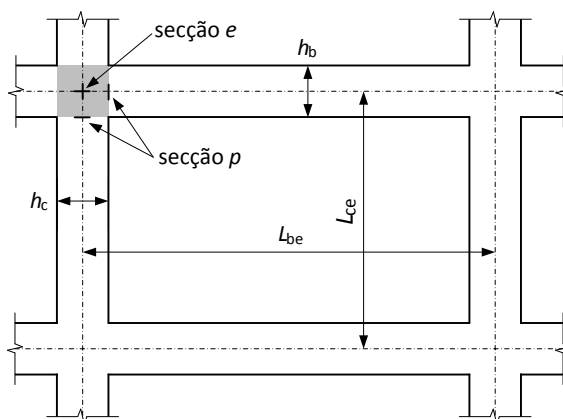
Alçado lateral (parcial) de uma estrutura porticada plana.
